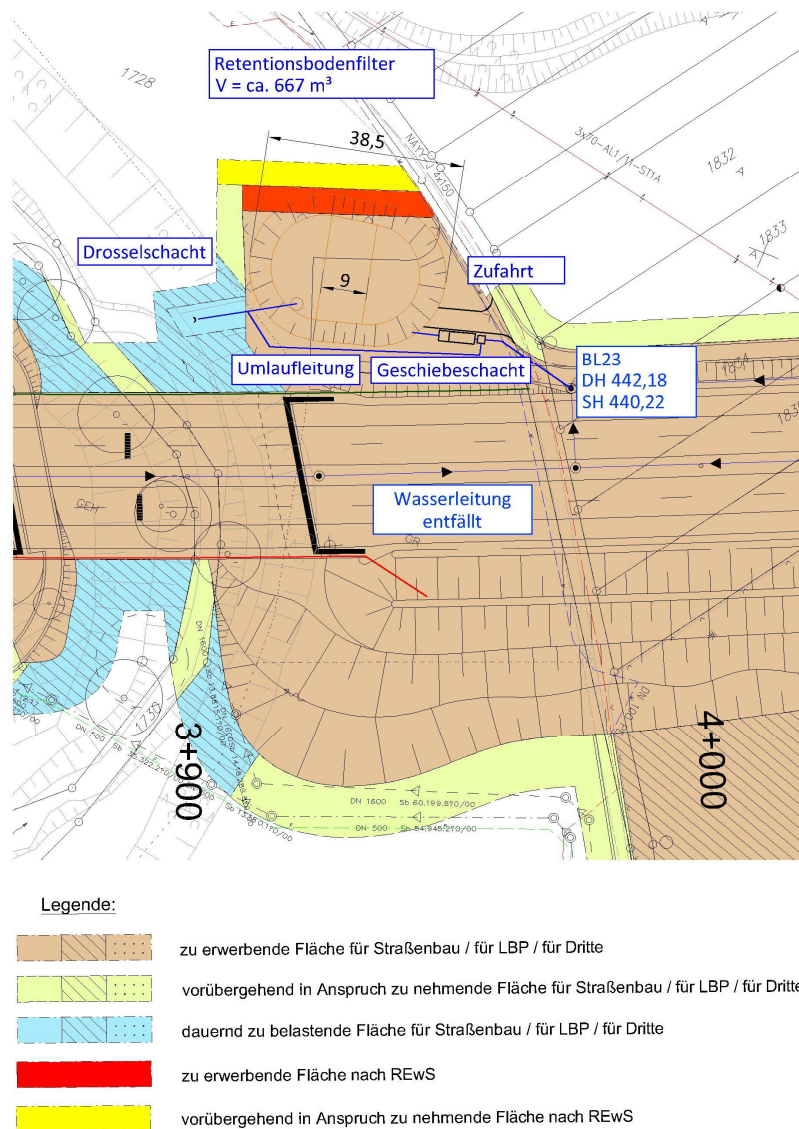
Entwässerungsabschnitt 2: Grundriss Retentionsbodenfilteranlage. Ohne Maßstab
